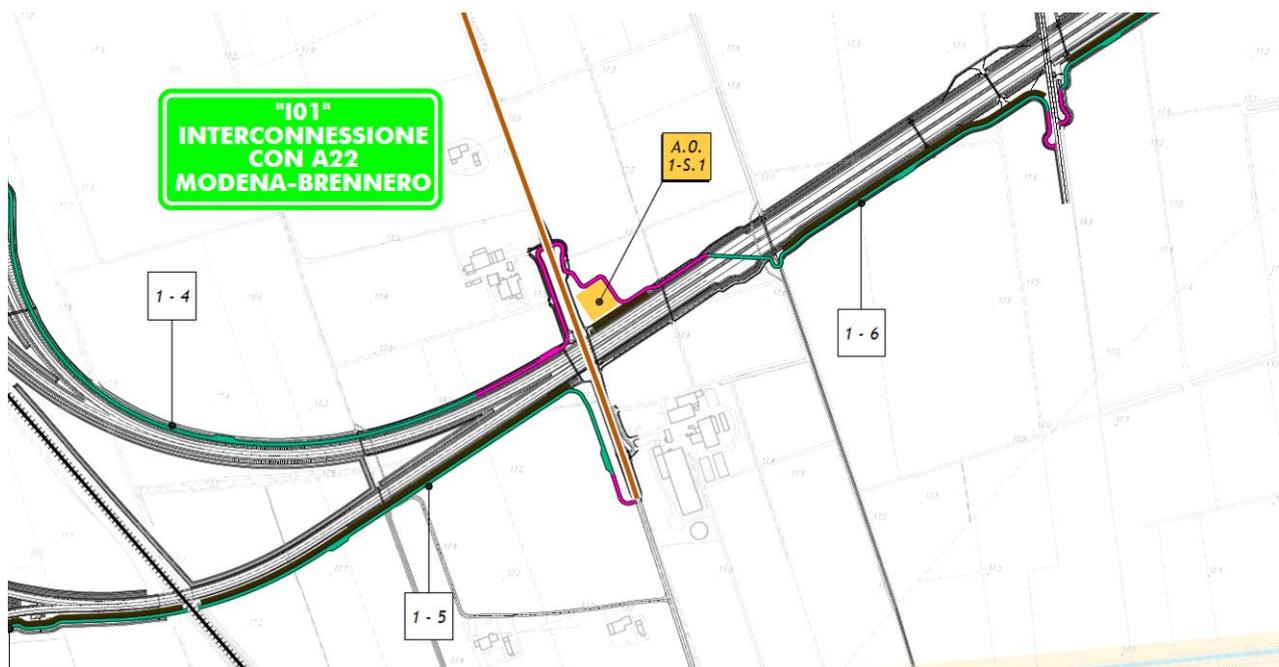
STRALCIO PLANIMETRICO DELLA PISTA 1-6 (ESTRATTO DALL'ELAB. PD_0_A00_AKK00_0_KK_P5_01)
